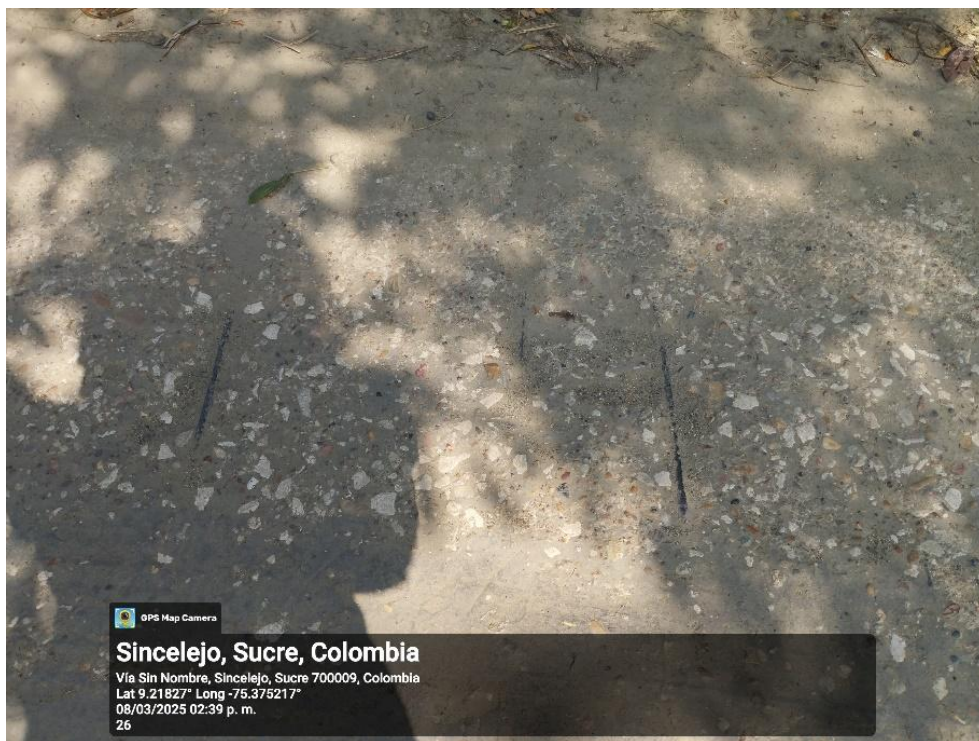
Exposición de acero de refuerzo Pontón K3+613
